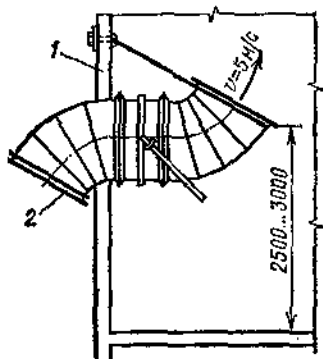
Схема организованного подвода воздуха в рабочее помещение элеватора:
